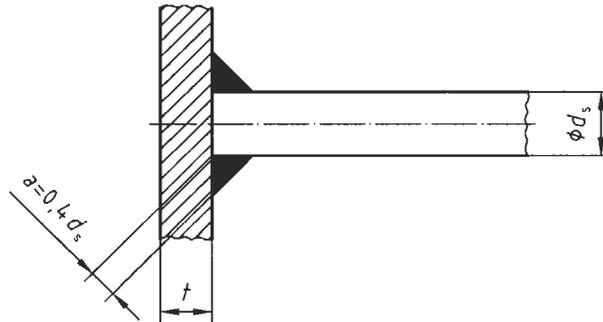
Stirnkehlnaht am durchgeführten Stab
